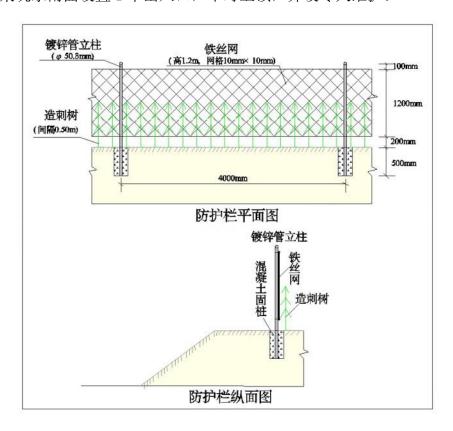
矿坑铁丝网+造刺树防护围栏纵平面图
